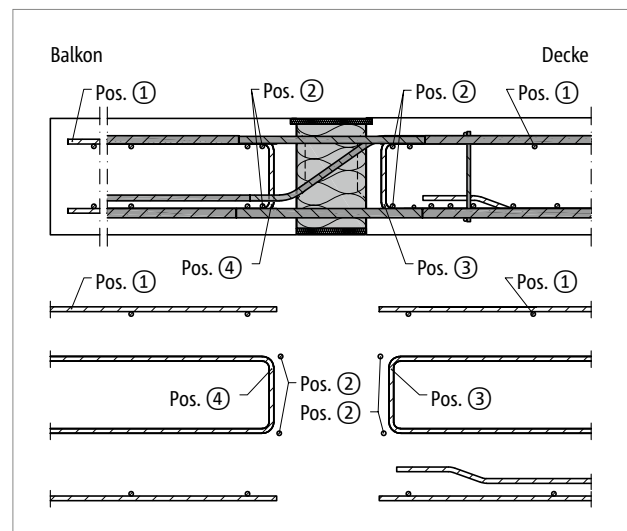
Schöck Isokorb® XT Typ K-M12 bis M13: Bauseitige Bewehrung bei indirekter Lagerung
